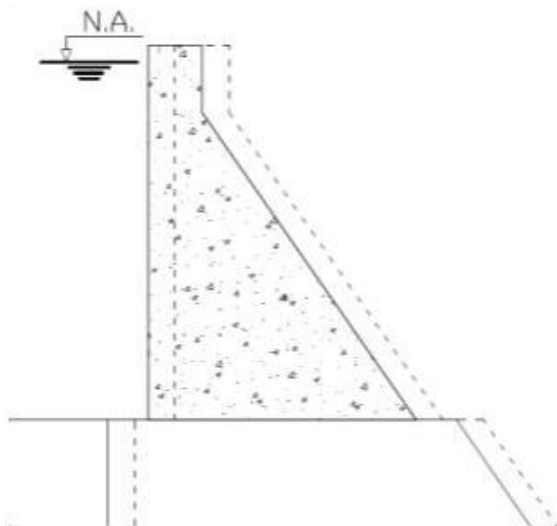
DESLIZAMENTO NA FUNDAÇÃO
